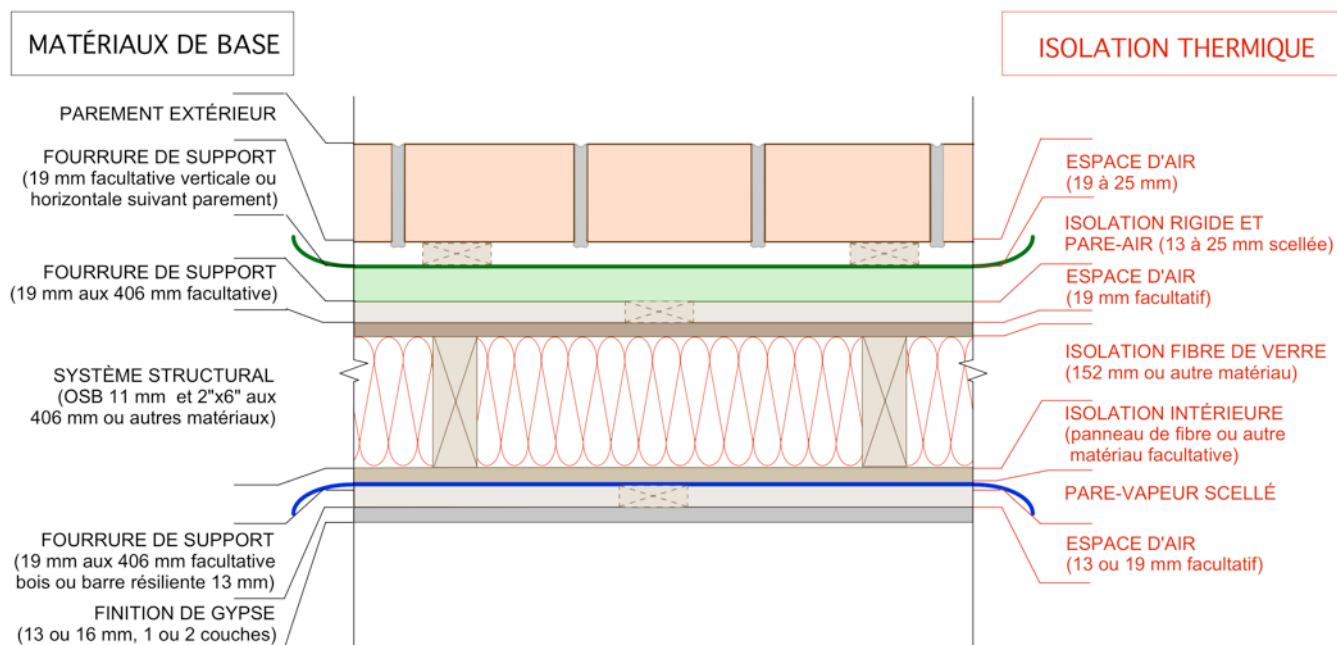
Constitution d'un mur de façade et localisation des différentes parties
